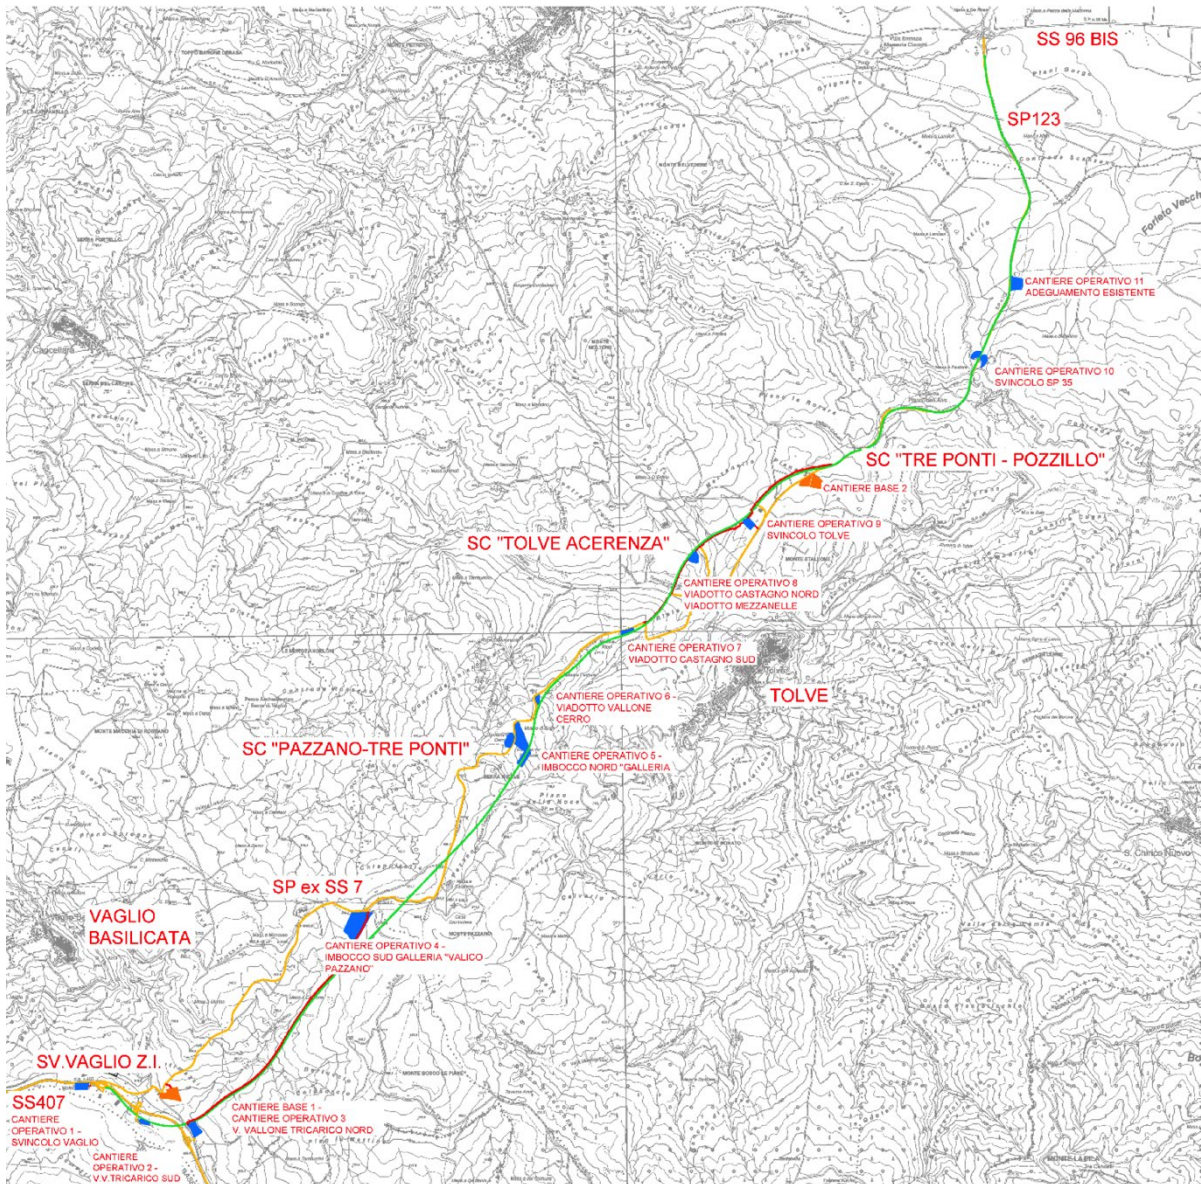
TRACCIATO DI PROGETTO, AREE DI CANTIERE E VIABILITÀ
